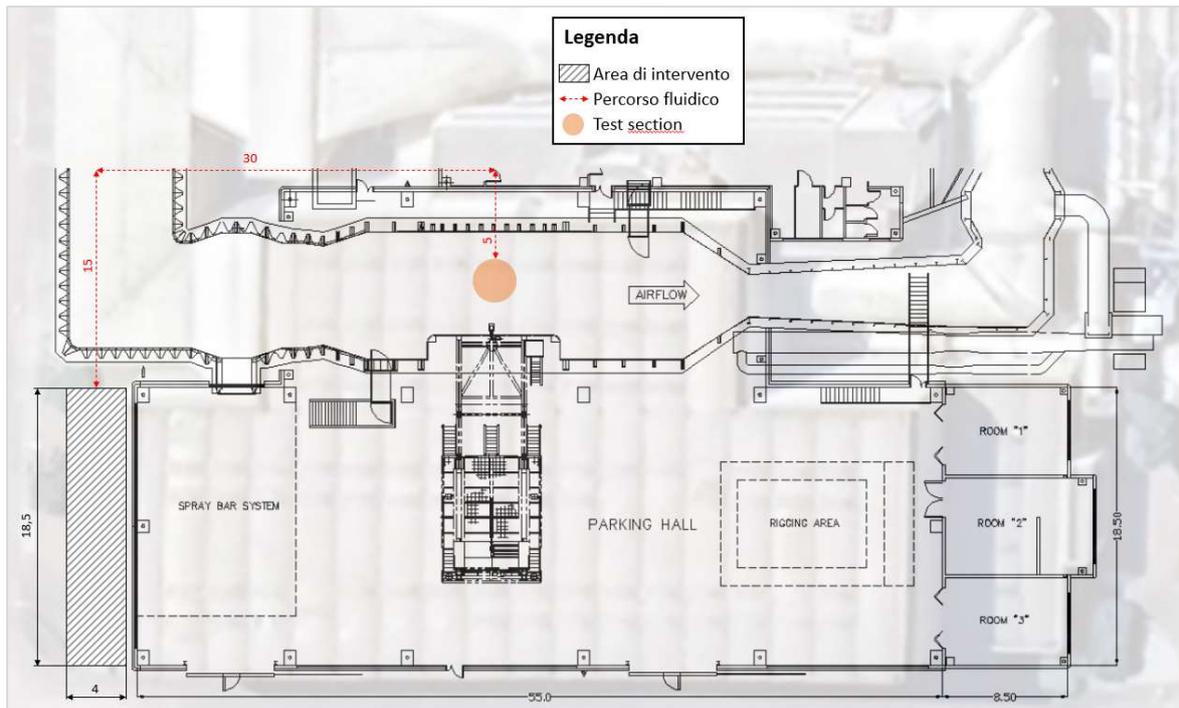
Dettaglio della planimetria della galleria IWT e della Parking Hall.
